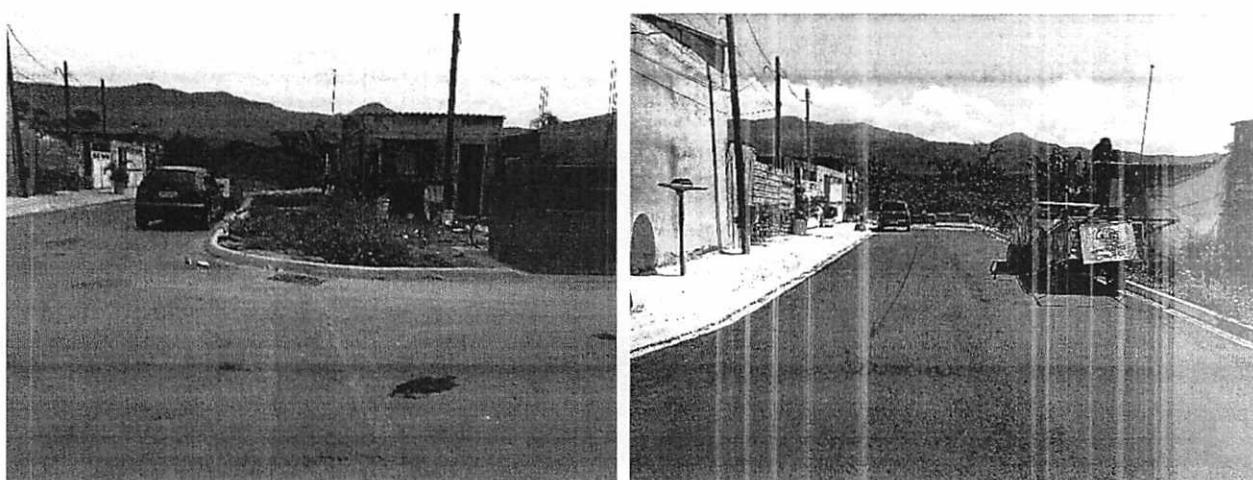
foto do local após a execução do pavimento e a manutenção da vala, necessária ao escoamento pluvial
